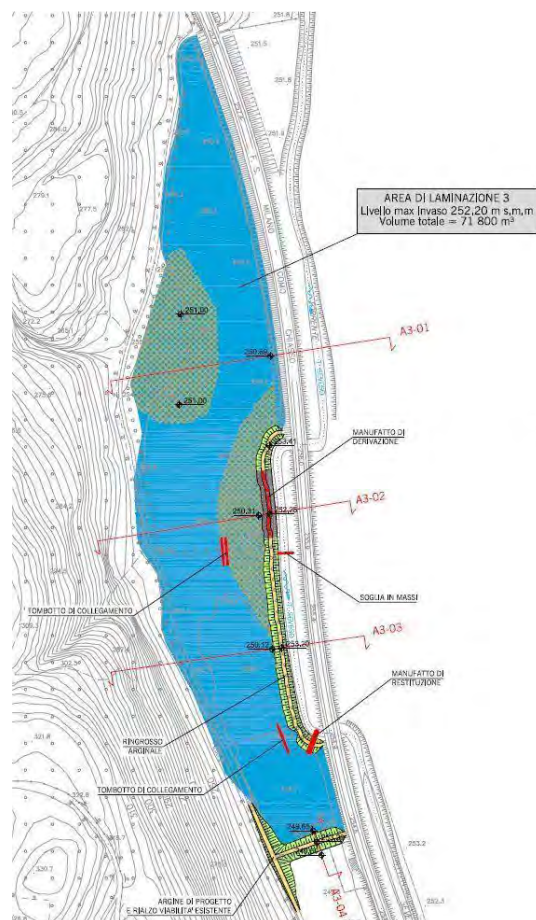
Planimetria delle aree golenali da progetto preliminare
